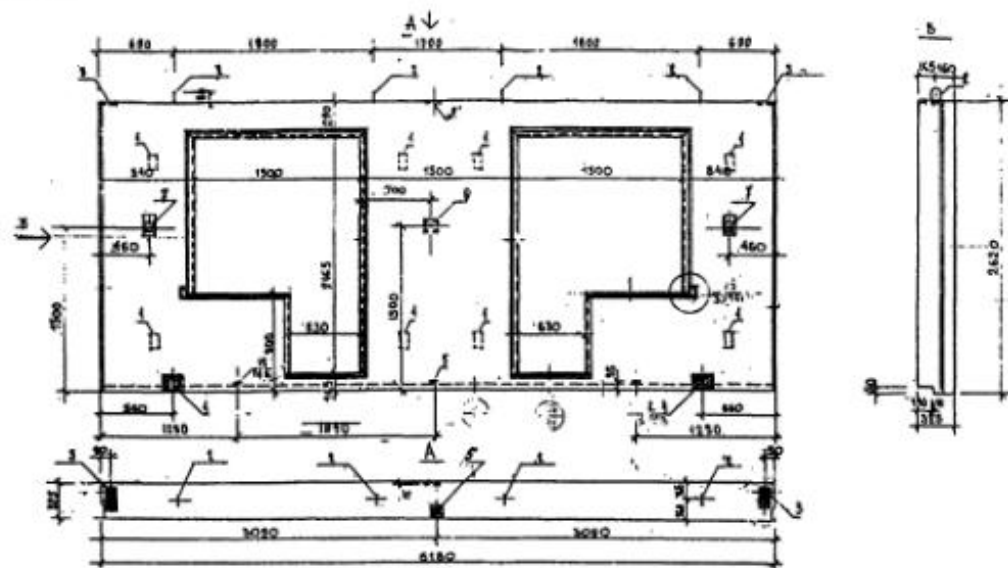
Трехслойная бетонная панель с бетонными шпоночными связями между слоями: 1 - бетонная шпонка; 2 - подъемная петля; 3 и 4 - закладные детали; 5 и 6 - связевые элементы; 7 - петлевой выпуск
